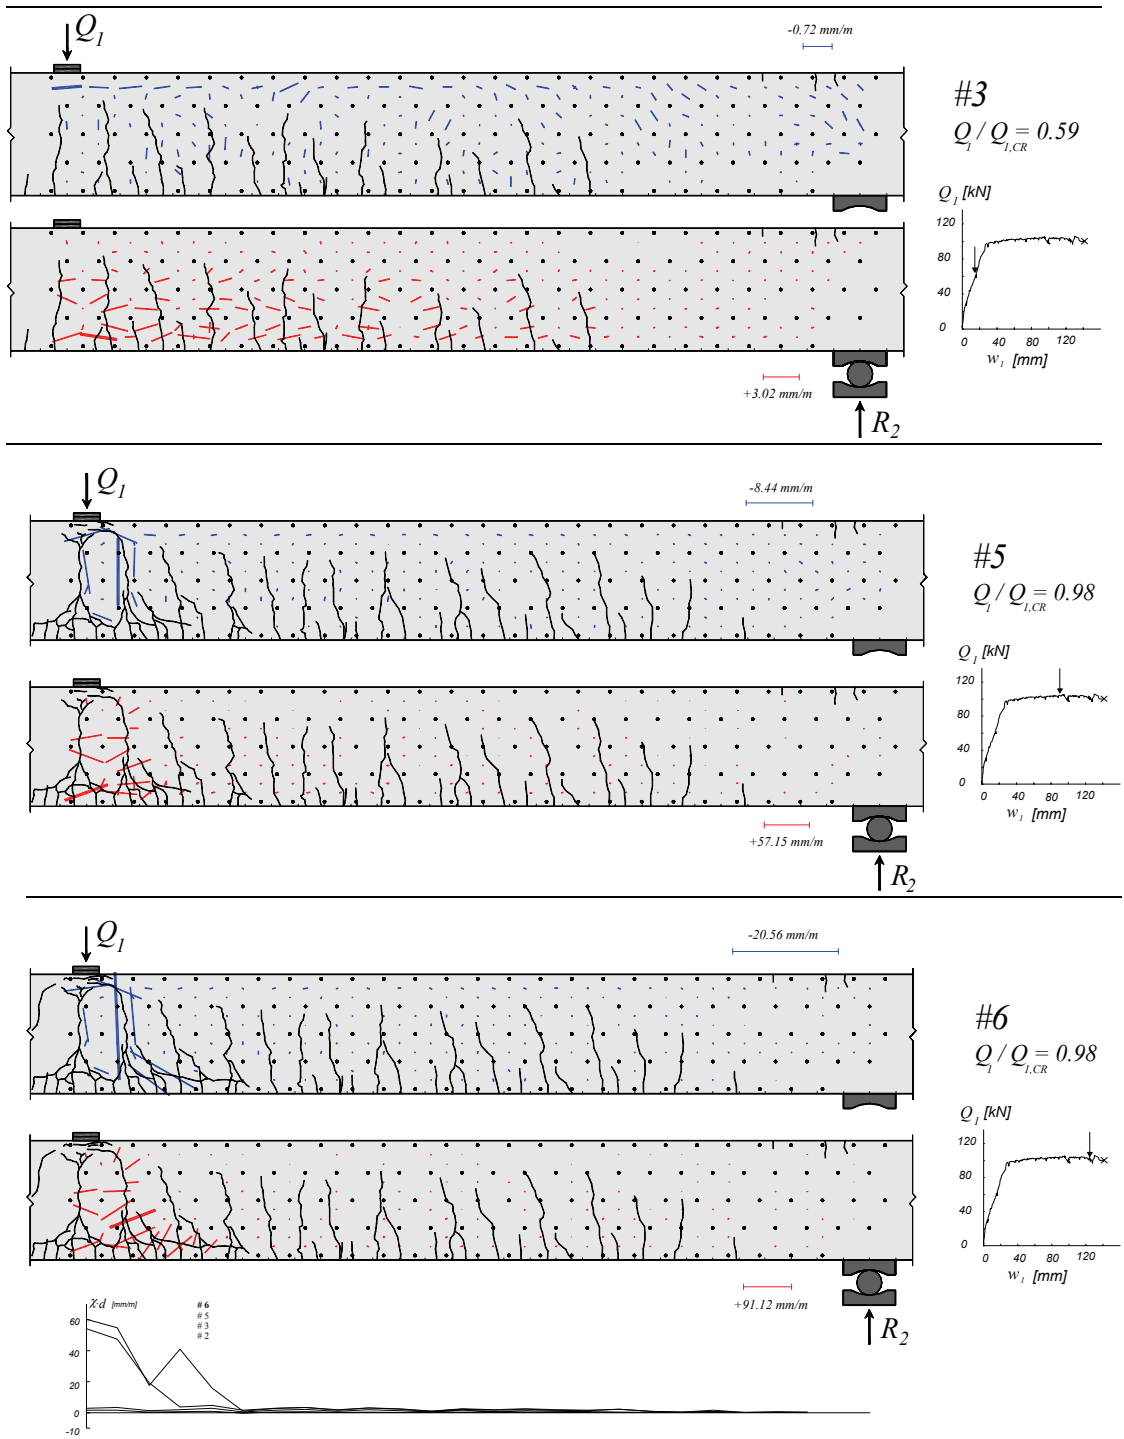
Poutre SR10: déformations principales, fissuration et courbures
